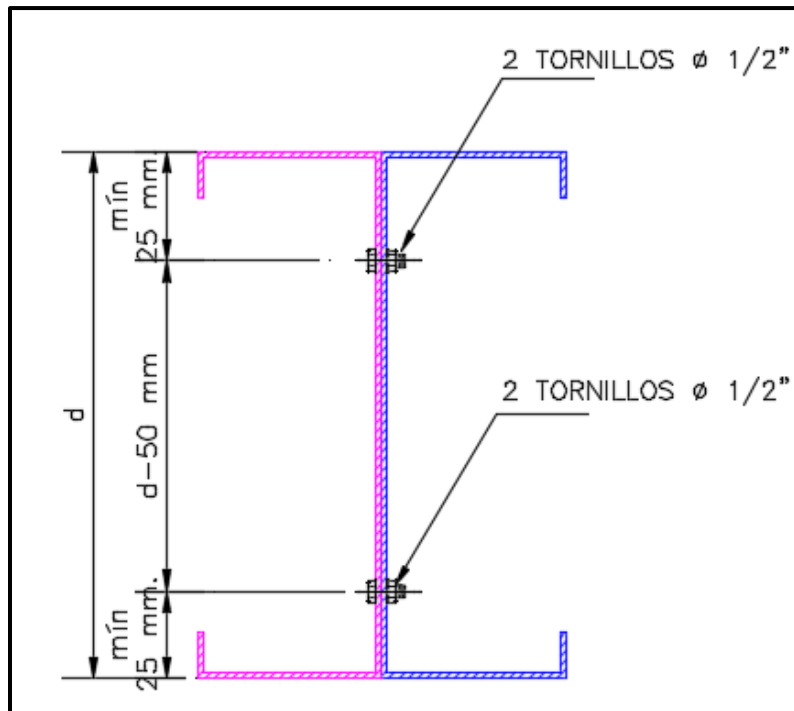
Traslape de perfiles ZF, vista transversal (autoría propia, 2021).
